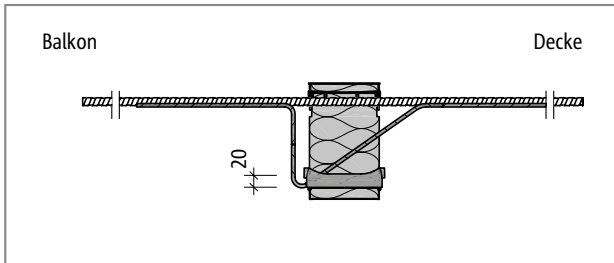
Schöck Isokorb® Typ KXT40-Combar-V6: Produktschnitt
